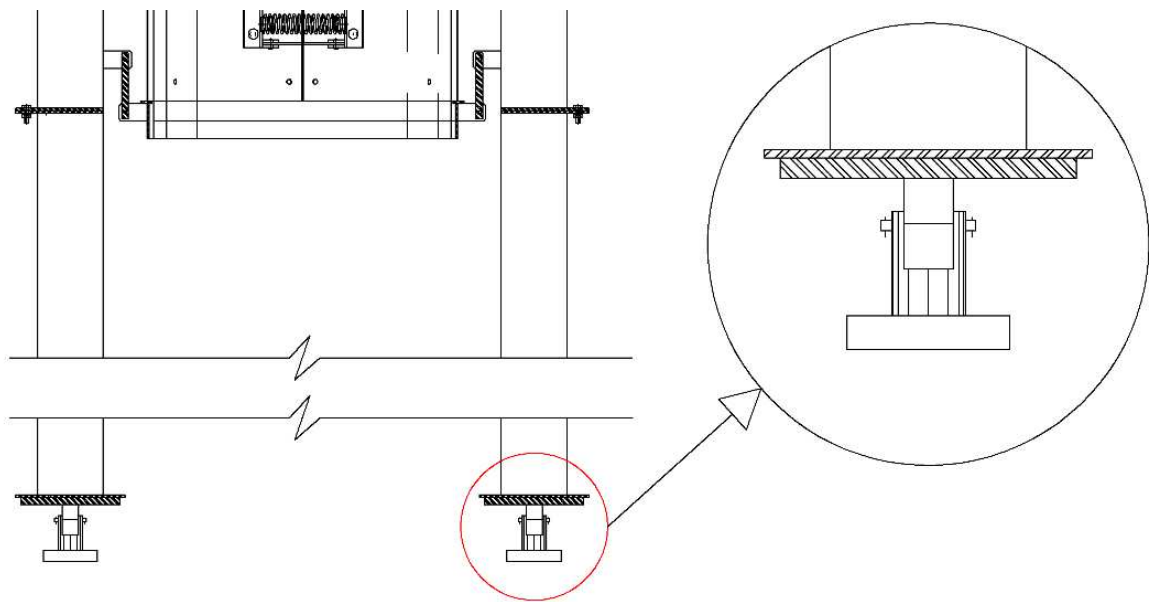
Geometria do silo piloto e visão detalhada dos anéis.
